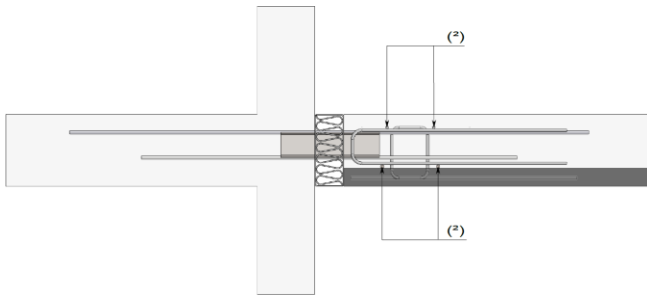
Chainage en rive de plancher – liaison dalle à prédalle – balcon – disposition 1
